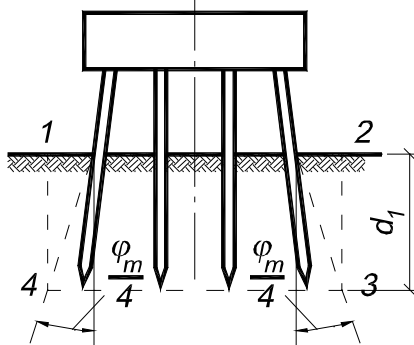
Умовний пальовий фундамент з ростверком, розташованим над ґрунтом при куті нахилу, паль менше ніж $\varphi_m / 4$
